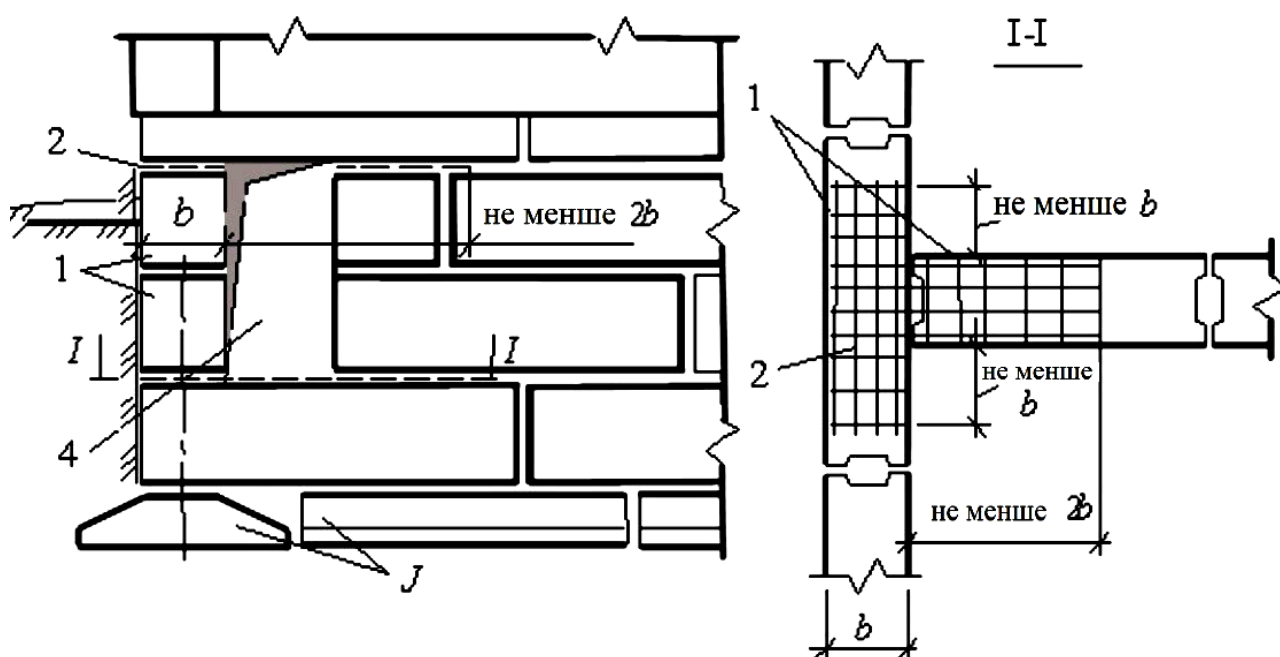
Влаштування отворів в стінах підвалу: 1 – блоки стін підвалу; 2 – арматурні сітки; 3 – фундаментні плити; 4 – отвір в стіні підвалу
